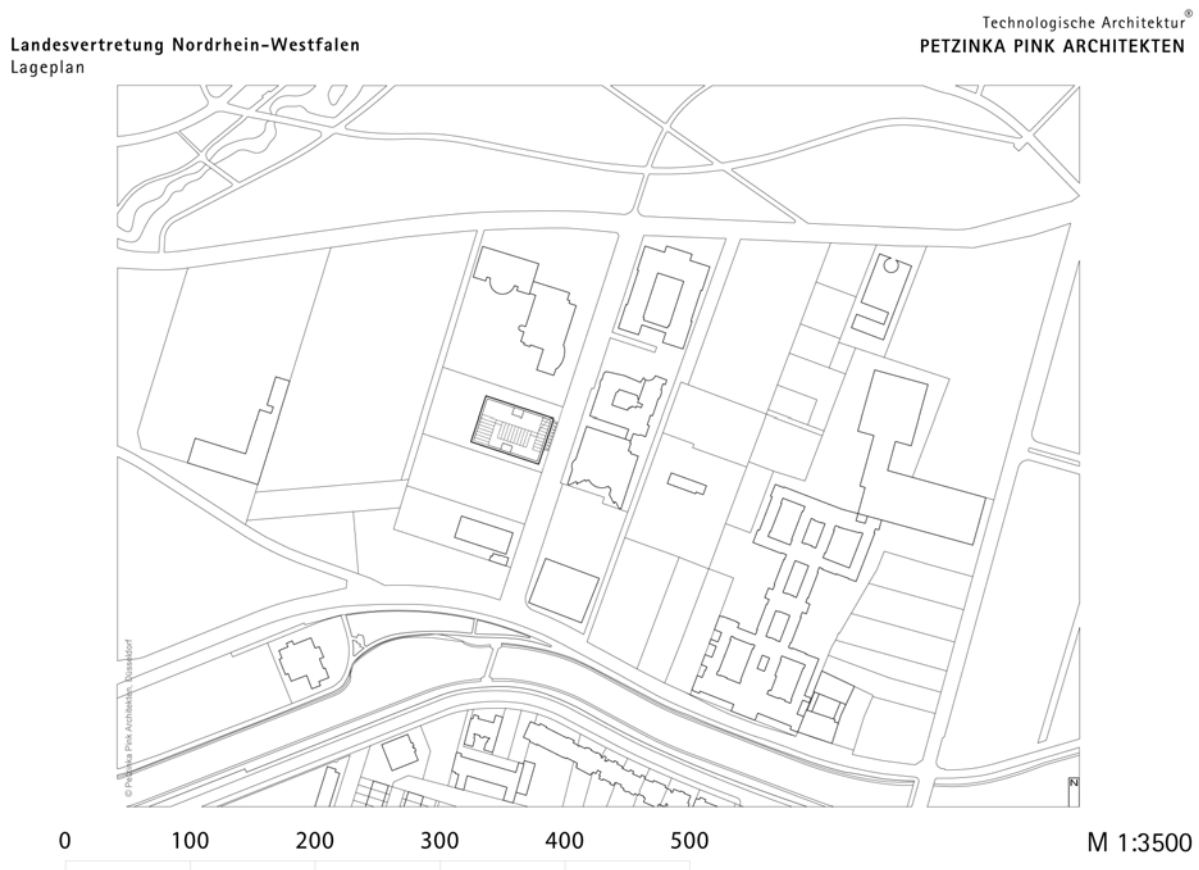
Lageplan der Landesvertretung NRW im Berliner Tiergartenviertel (Quelle: www.petzinka-pink.de)
